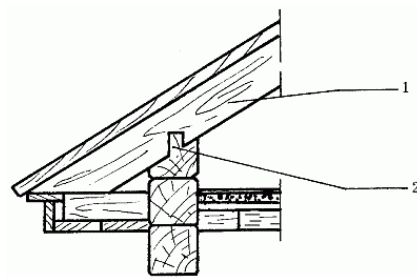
Наслонные стропила в деревянных брусчатых или рубленых зданиях: 1 – шип; 2 – стропильная нога
